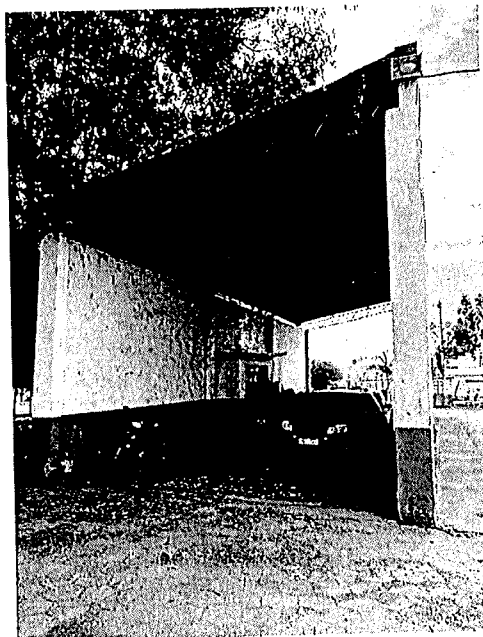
A área é definida por uma estrutura em pórtico, cuja sustentação é feita por pilares de concreto armado nas laterais, revestidos em argamassa e pintura. A estrutura de cobertura é metálica de uma única água, realizada com telhas metálicas corrugadas, suportadas por terças metálicas. A parede de fundo é construída em alvenaria de vedação, com acabamento de reboco e pintura. O espaço é aberto nas laterais, garantindo ventilação e acesso.
